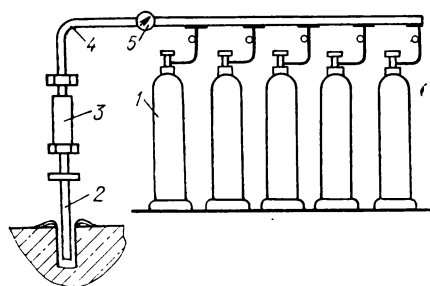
Оборудование для кислородно-копьевой резки бетона и железобетона:
